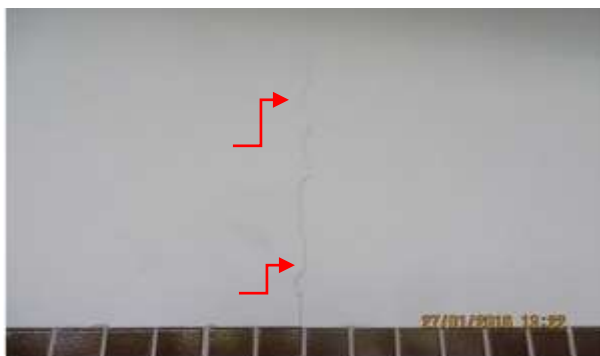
Fissura no encontro concreto x alvenaria.
